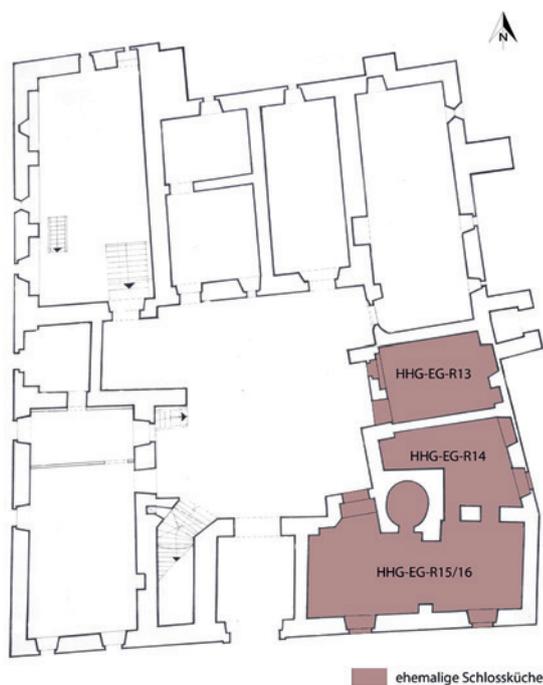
Lage der ehemaligen Schlossküche (Plangrundlage: M. Wehdorn 1975, adaptiert: I. Winkelbauer 2021)
